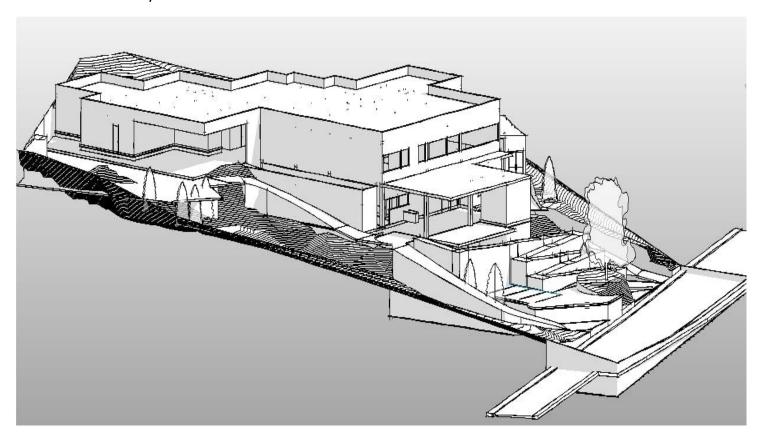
Conjunto de proyecto arquitectónico del centro de Salud Xichú.
